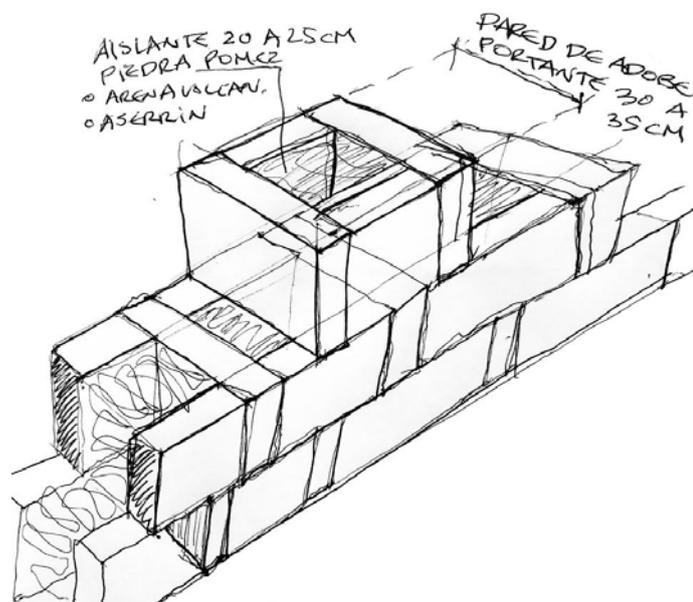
Detalle constructivo de la pared de adobe “traba hueca” (crédito: M. Aresta)
